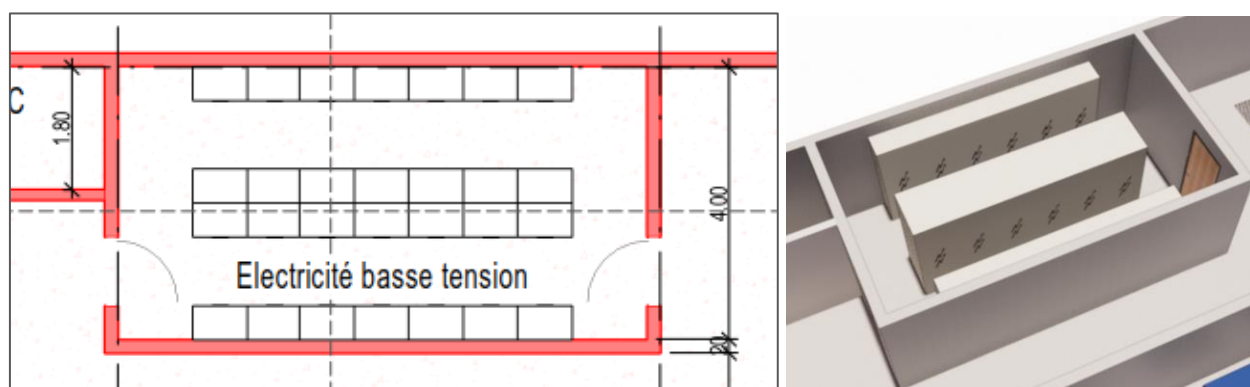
Plan d'installation des locaux électriques (basse tension)
